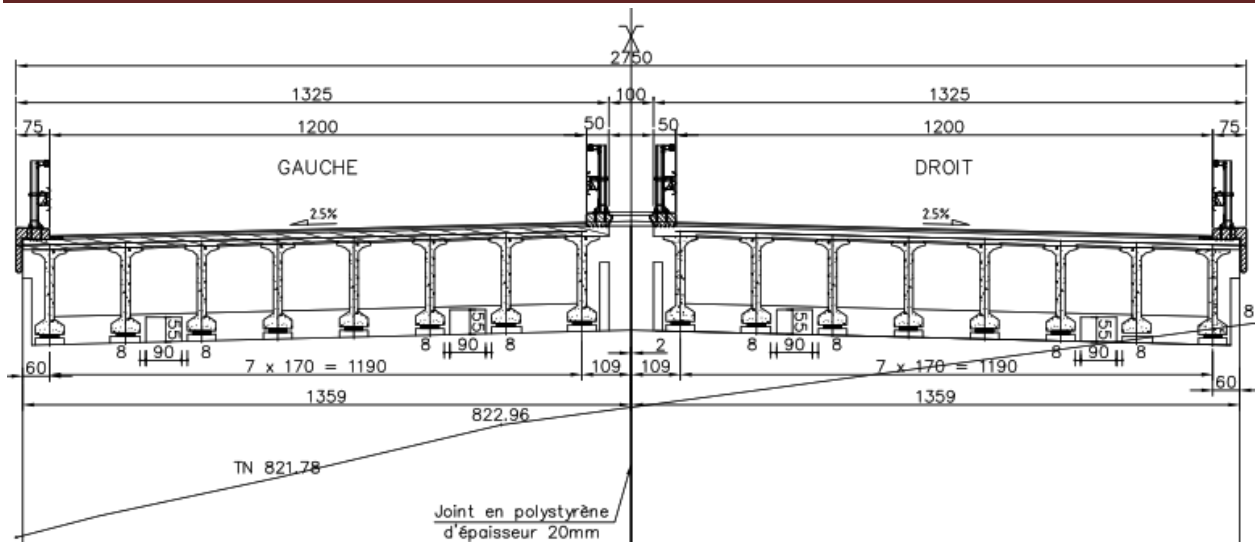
Coupe transversale de l'ouvrage (rapport SAPTA, 2018)
